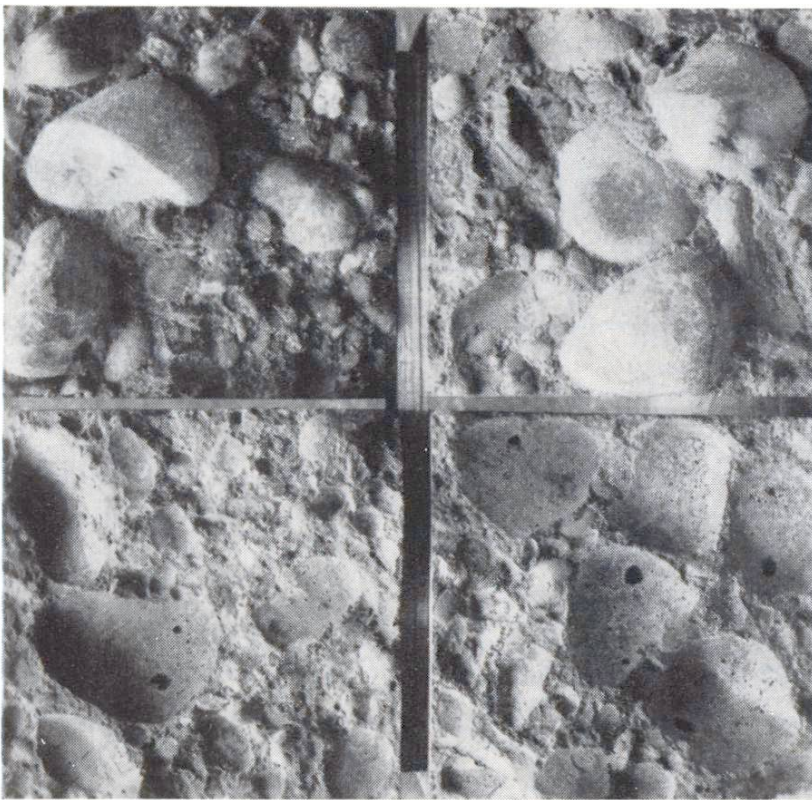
Die Wirkung der inneren Wasserabscheidung im Frischbeton zeigt sich beim Biegeversuch an senkrecht betonierten Prismen
